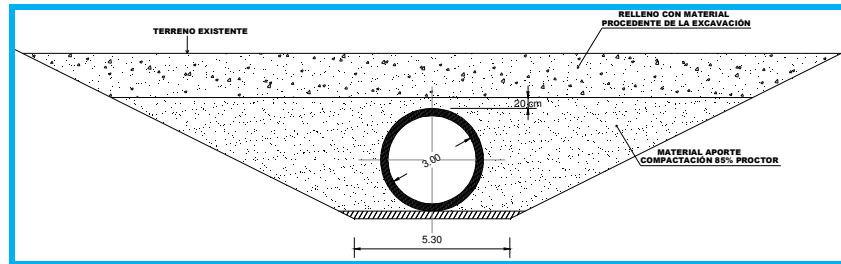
Sección típica de tubería enterrada en el Tramo Terrestre.
